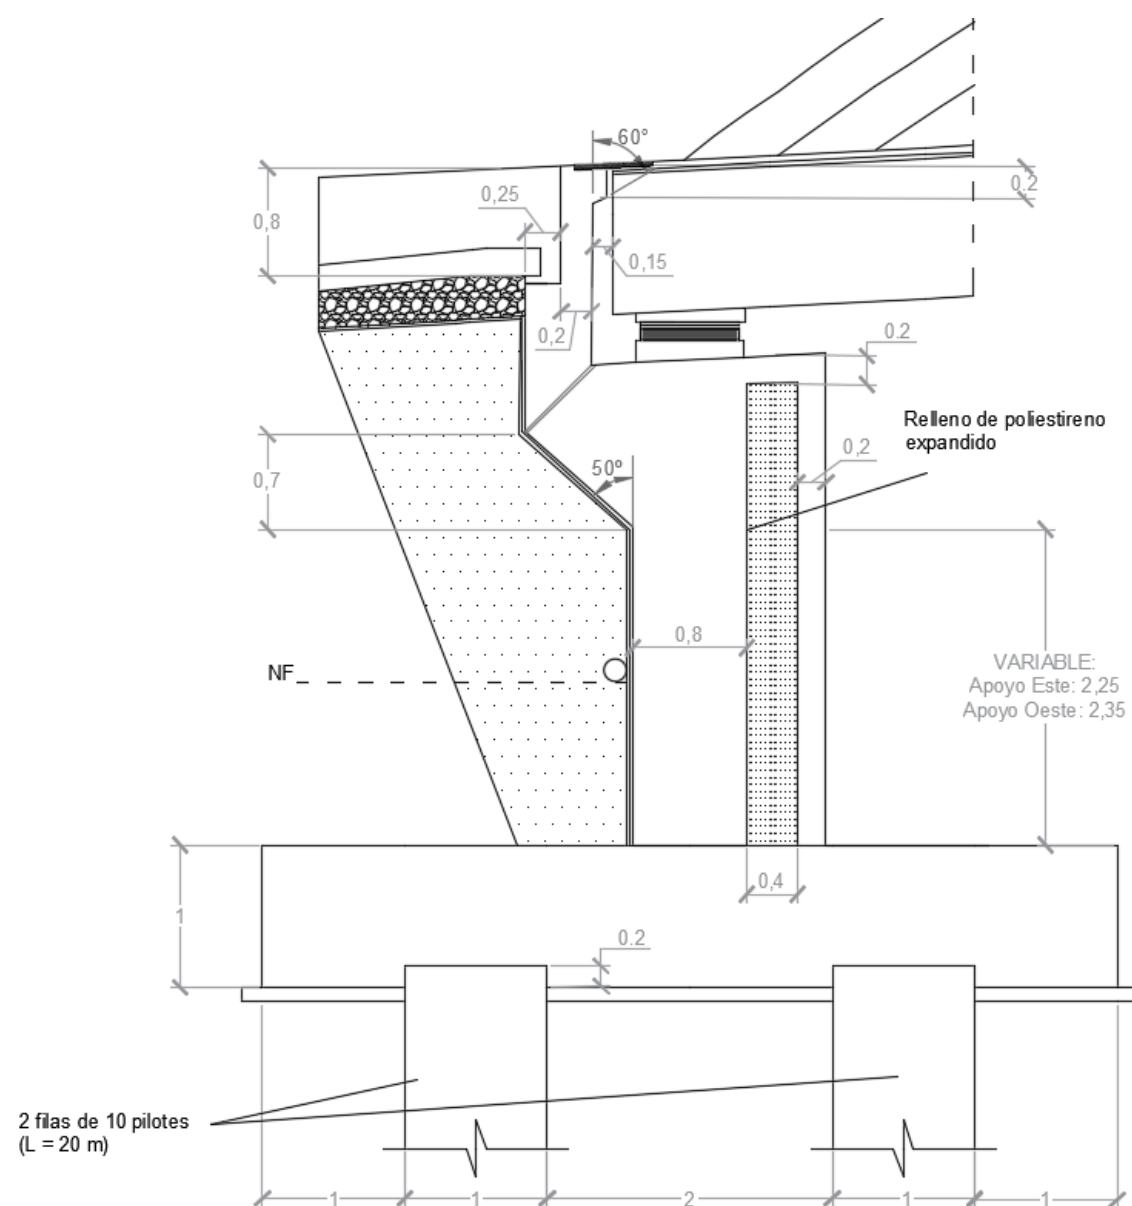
Geometría de los estribos. Elaboración propia con AutoCAD.
